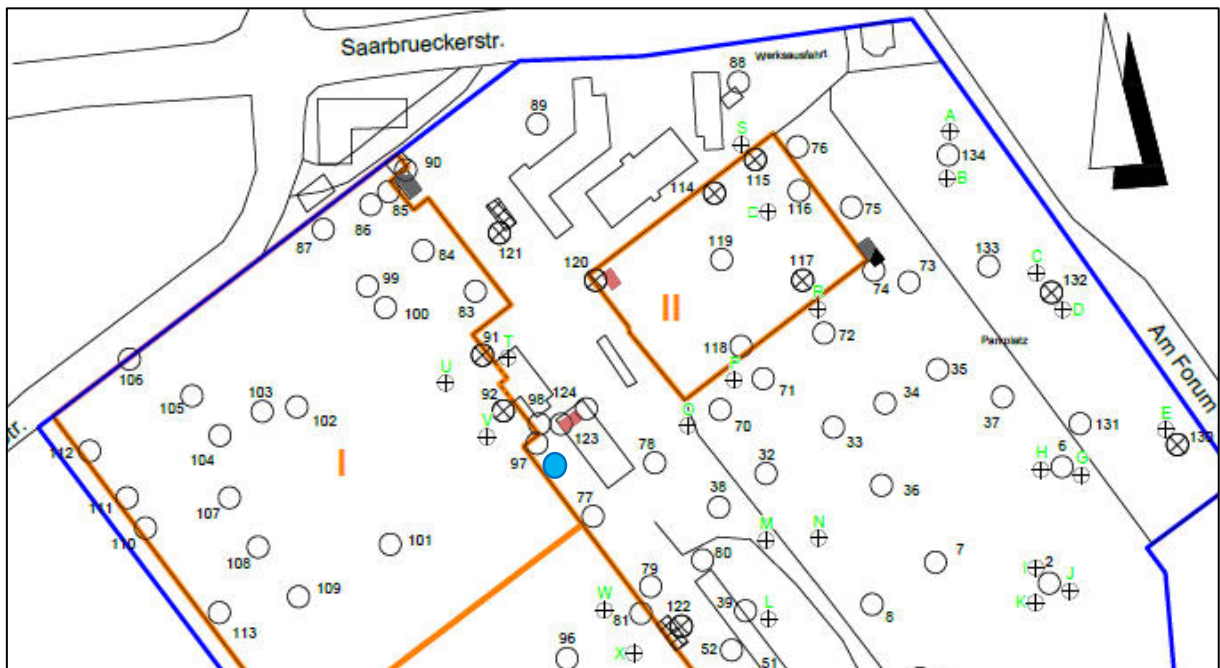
Lageplan der Rammkernsondierungen und ungefähre Lage des Brunnens II (blauer Kreis) gemäß Koordinaten (s. Tabelle 1) [5]
